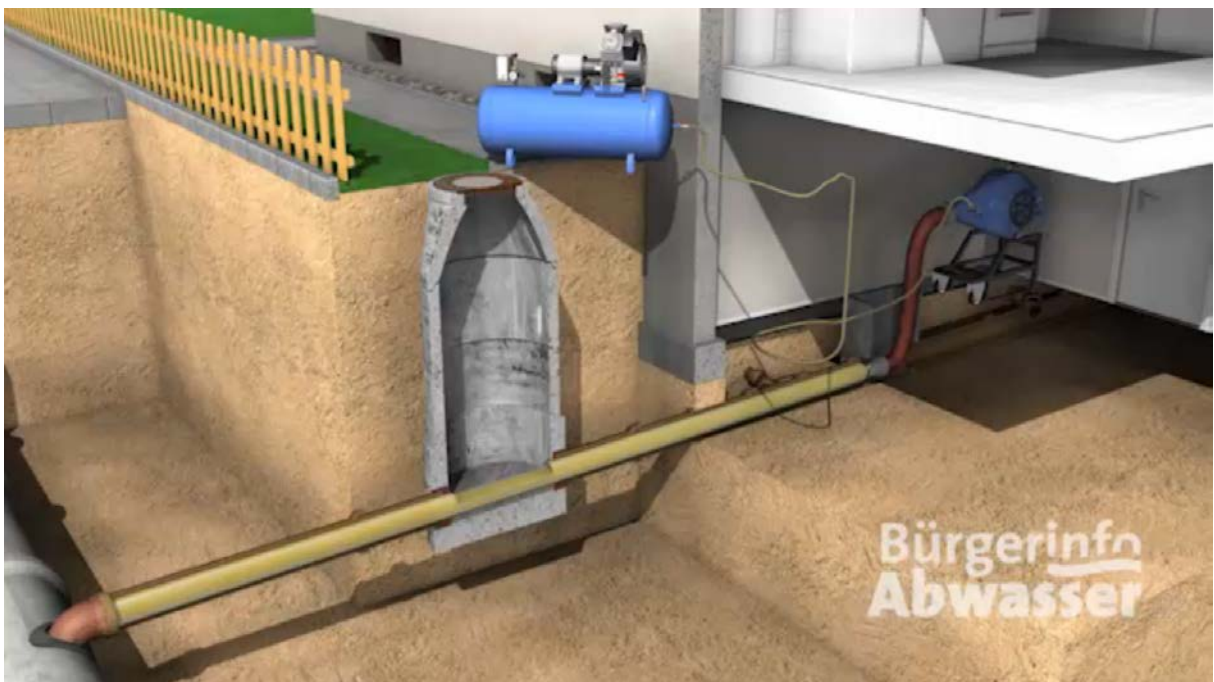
visaplan Film „Bürgerinformation zur Grundstücksentwässerung“, Bildeindruck
